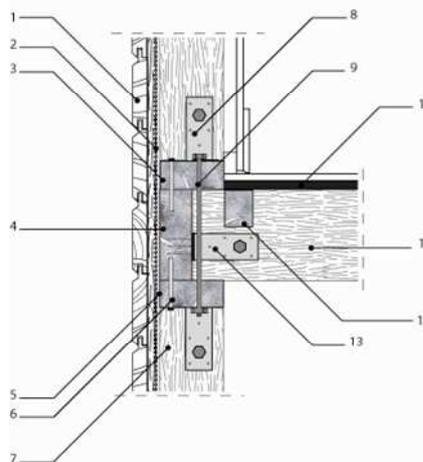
Coupe de principe sur l'assemblage de murs courants secondaires entre un mur de refend et un mur de façade
